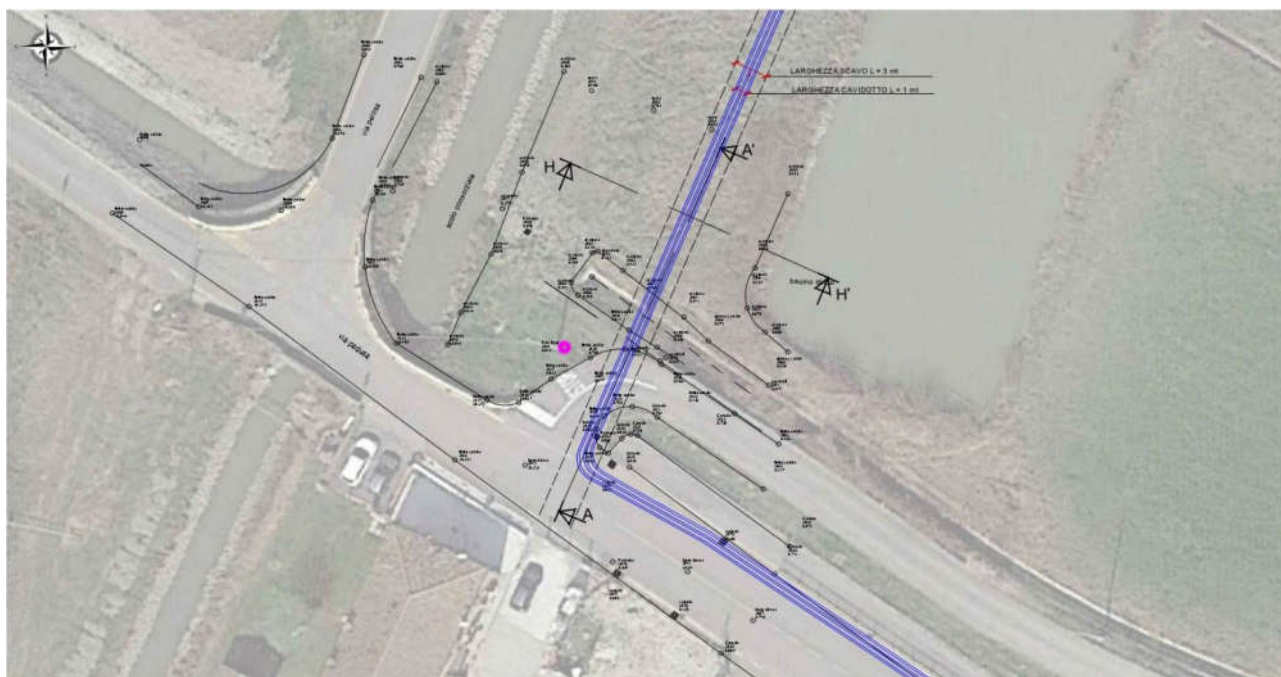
Tratto A-A' - Rilievo planoaltimetrico post-intervento
